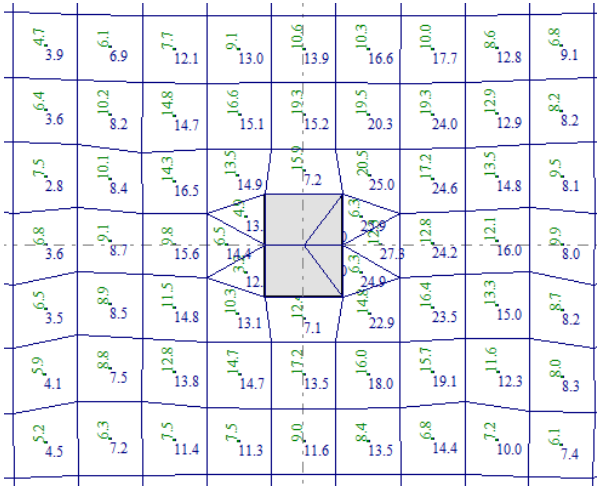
Армирование плиты в цифровом виде (фрагмент)
